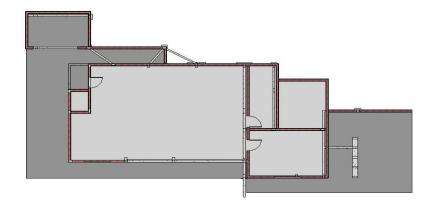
Pavimento baldrame a compatibilizar Fonte: Autoria Própria - Extraído do Software Revit Building (2017)
